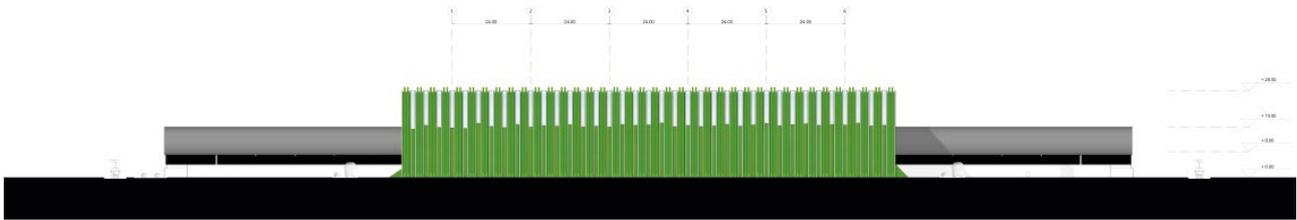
| Prospetto SudEst landsideal 2035 con vista del Tetto verde da Viale Luder
